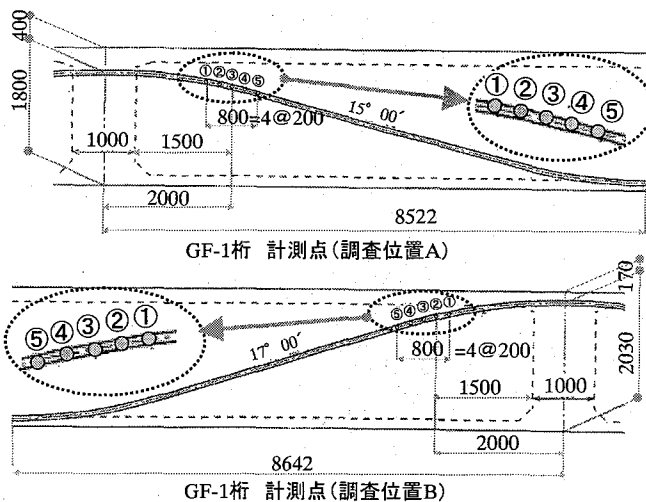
桁側面およびケーブル配置図：F 橋梁 GF-1 桁
